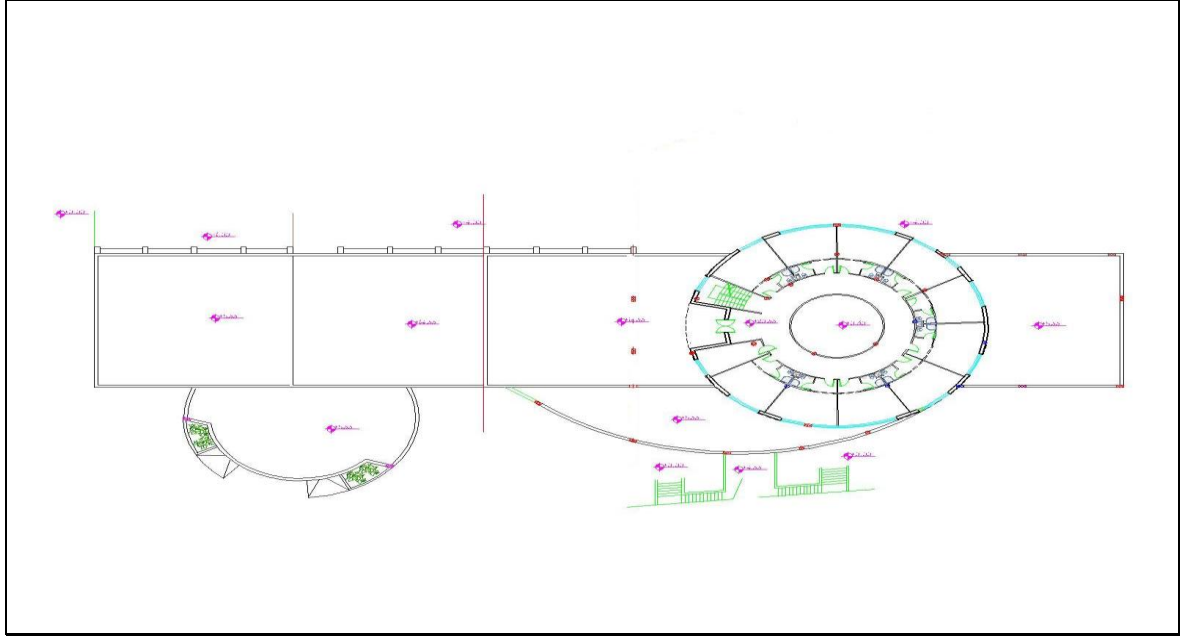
صورته لمسقط الطابق الثاني .
